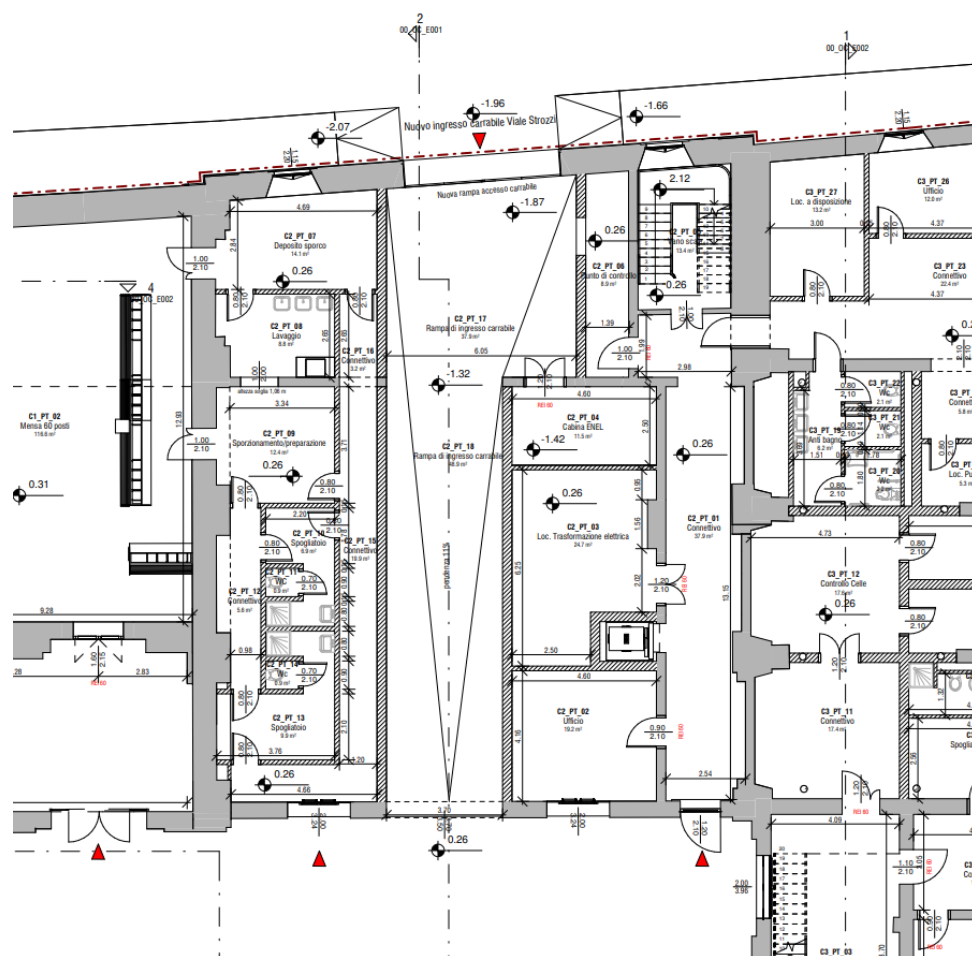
dettaglio planimetrico del nuovo ingresso carrabile. Raccordo del marciapiede.
